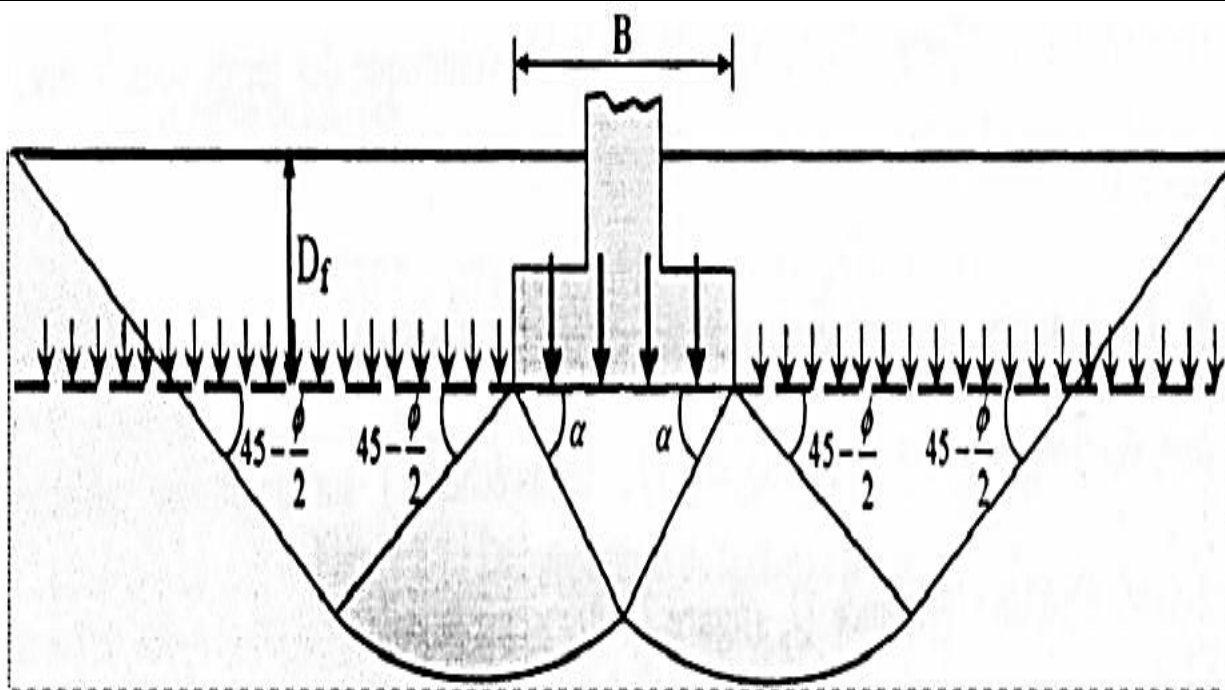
Mécanisme de rupture d'une fondation de base rugueuse [Terzaghi (1943)]
